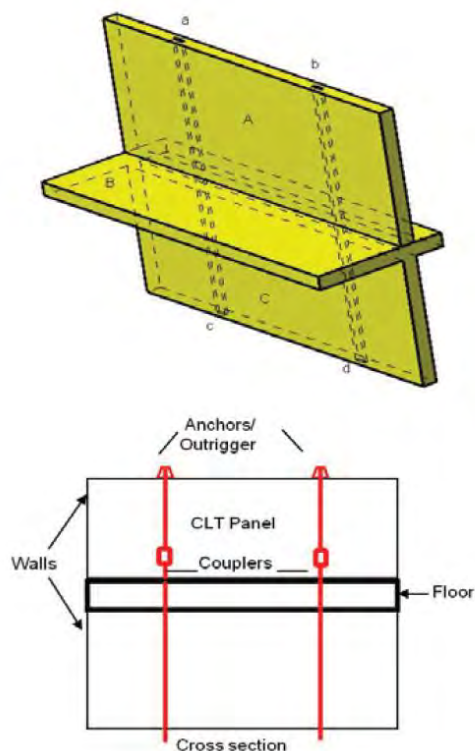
Immagine tratta da “Very tall wooden buildings with cross laminated timber” J.W.G Van De Kuilen et al. 2011.
